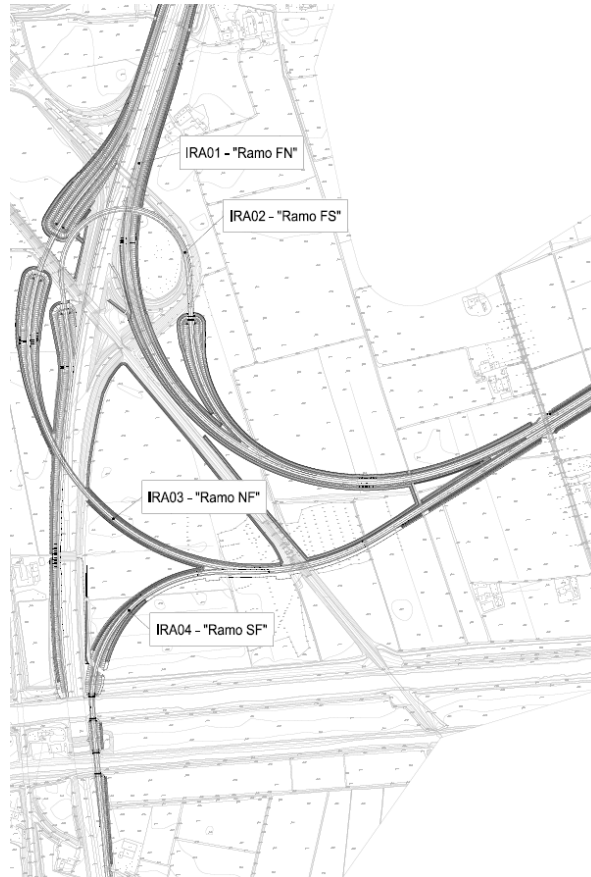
SCHEMA PLANIMETRICO SVINCOLO INTERCONNESSIONE CON L’AUTOSTRADA A22
